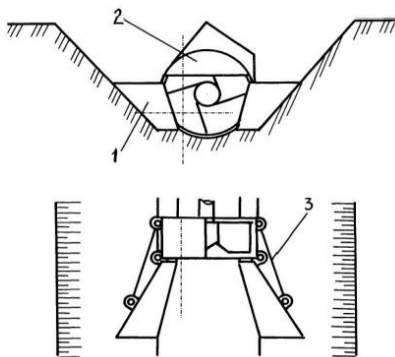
Фрезерный рабочий органа с открьлками.
